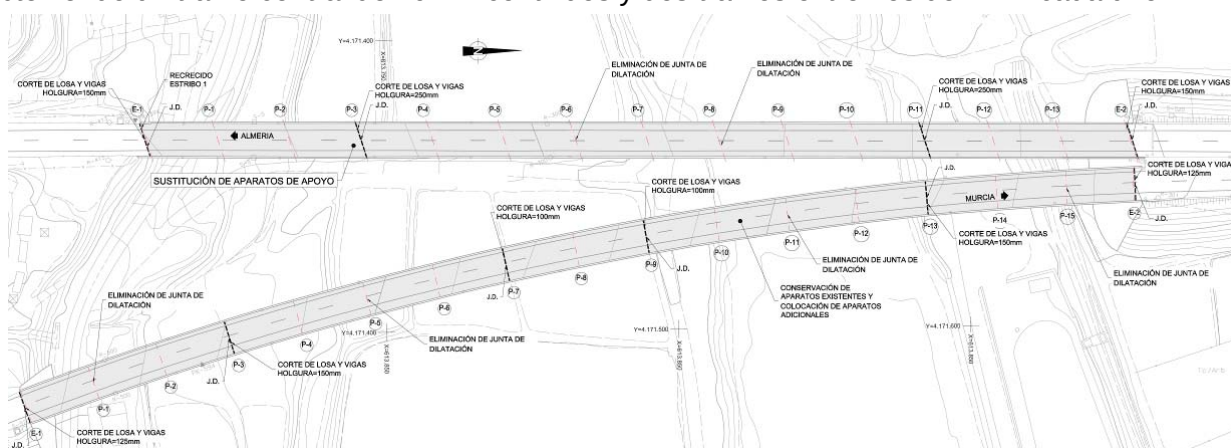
Planta de tableros con eliminación de juntas y tramos definitivos con continuidad.
